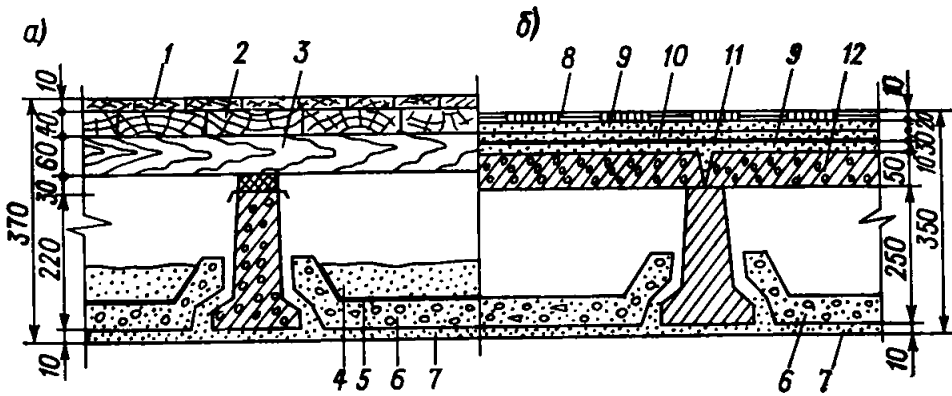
Перекрытие по железобетонным балкам таврового сечения
